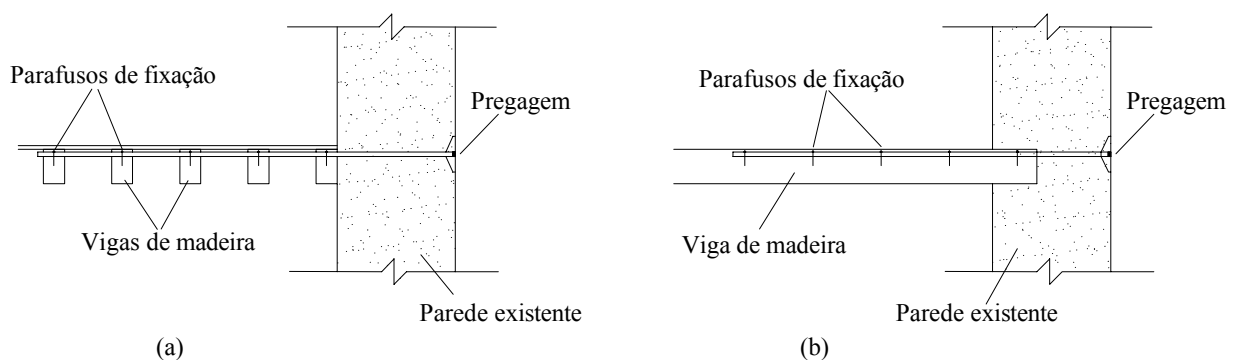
Pregagens entre paredes exteriores e os pavimentos: (a) vigas paralelas à parede; (b) vigas ortogonais à parede.
